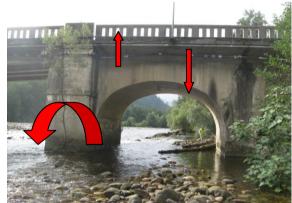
Giro longitudinal de pila por erosión lateral de cimentación, con el consiguiente movimiento y agrietamiento de la bóveda.
